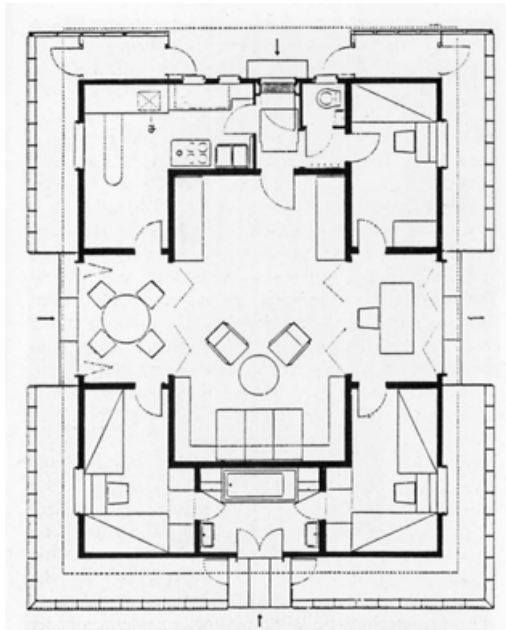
Das wachsende Haus - Martin Wagner, Grundriss
